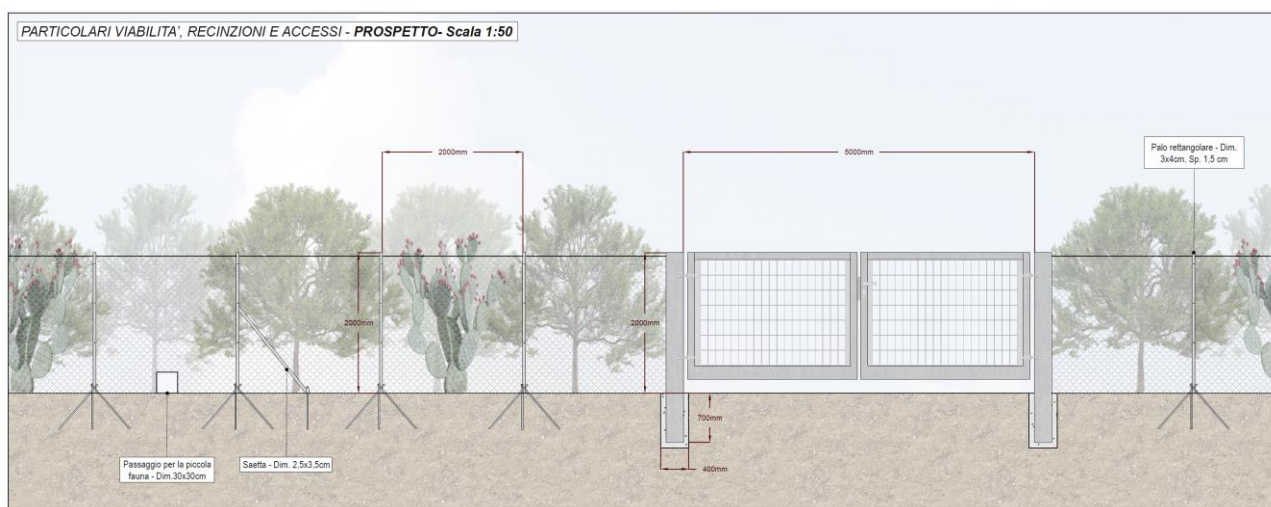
Particolare recinzione perimetrale con passaggio piccolo fauna
